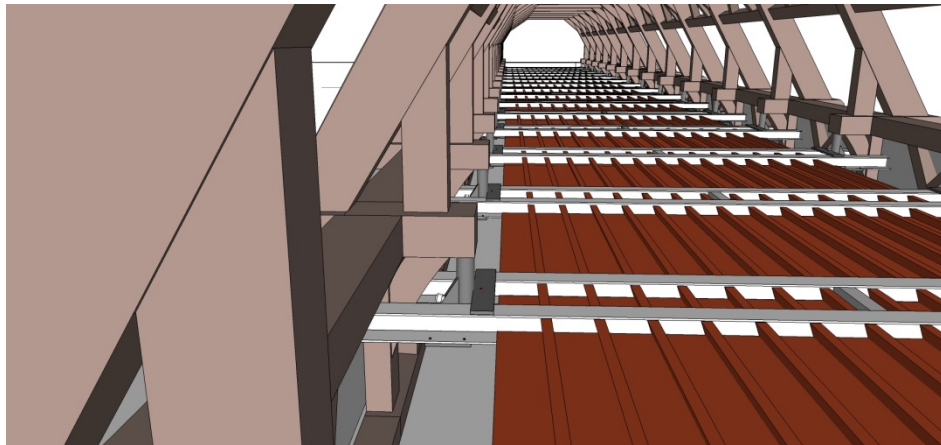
Les tôles de coffrage de la dalle fixées entre les poutres IPE.
